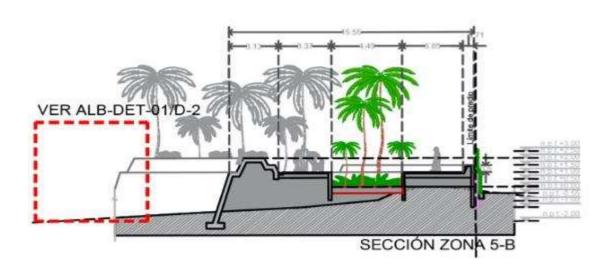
Corte lateral de la zona 5. Construcción del Malecón Salina Cruz.
